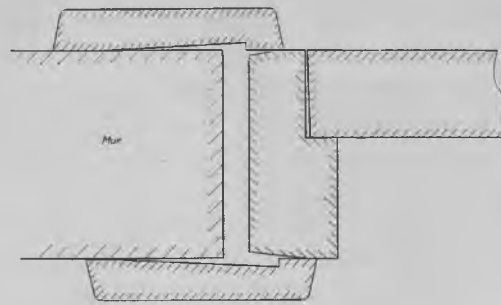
Karmtræet er smig på kanterne for at kunne tage forskellige murtykkelser, når indfatningerne samtidig er underkehlet, som vist, giver det en stor tolerance.
